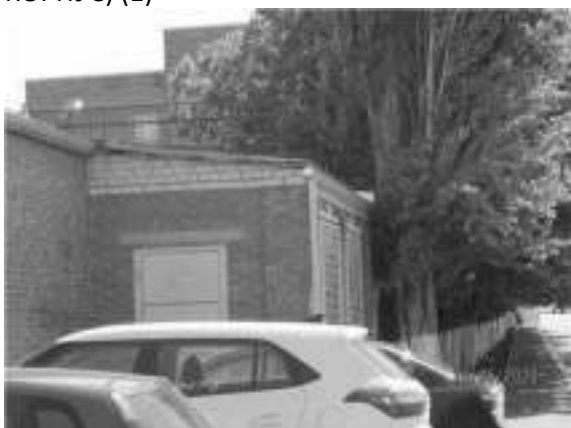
ЛИТЕР Д (ЛАБОРАТОРНО-БЫТОВОЙ КОРПУС) (3)
